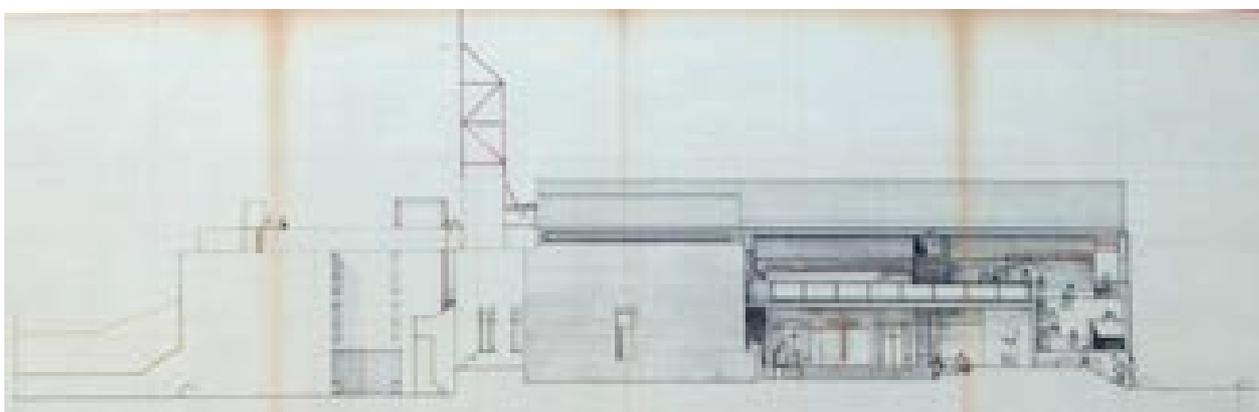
Prospetto Est, stato sovrapposto –09/12/1997 (AABS-1996.500)
